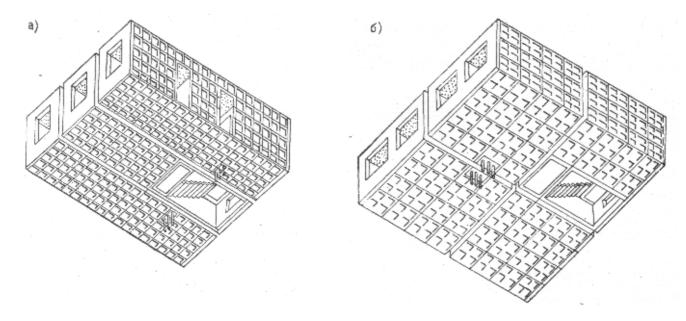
Объемные блоки из прокатных панелей a — на всю ширину корпуса; δ — на половину ширины корпуса
